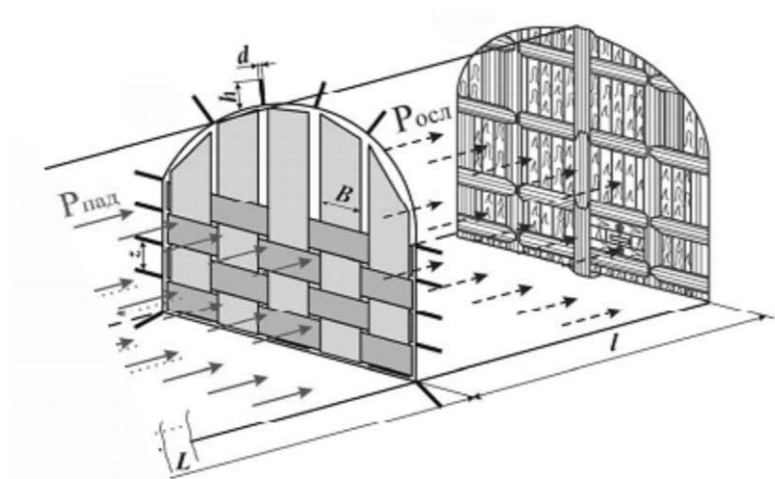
Гнучка конструкція з поліестерної стрічки для послаблення УПХ перед вибухозахисною спорудою [64]
